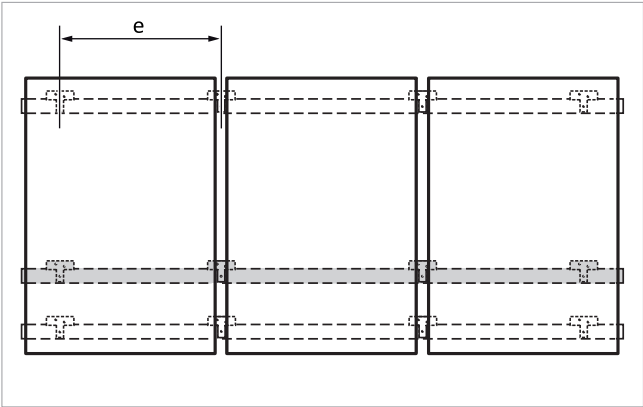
rail de support supplémentaire (montage l'un à côté de l'autre)
